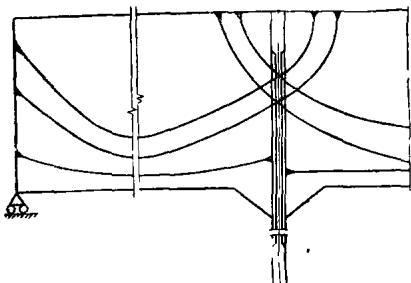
Схема соединения балок над опорой посредством заанкеренных стержней
